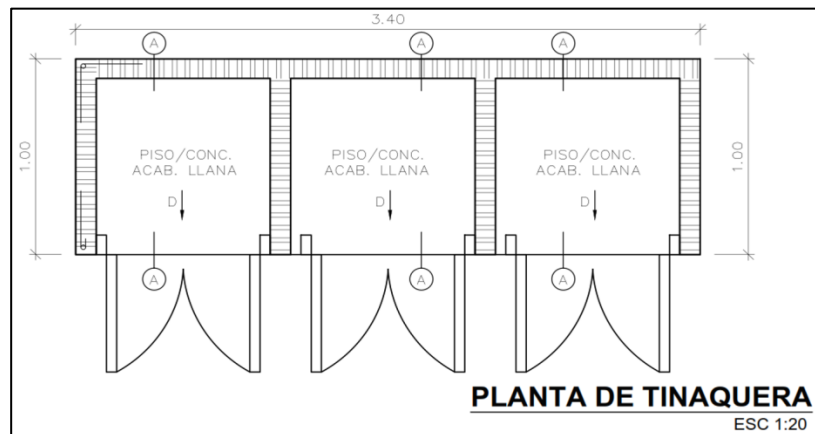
Planta de la tinaquera. Fuente: Planos de anteproyecto
